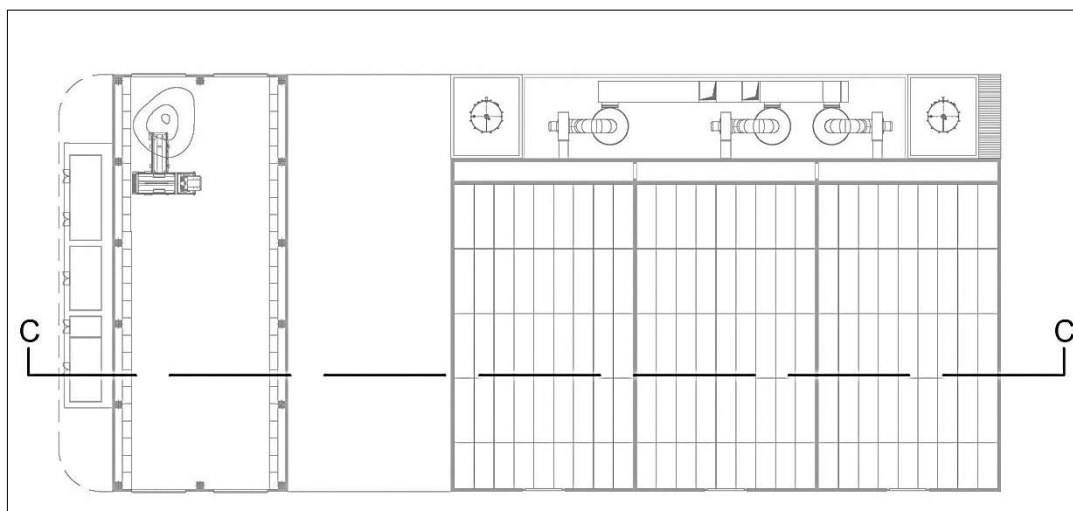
PLANIMETRIA AREA STOCCAGGIO E BIOFILTRO
